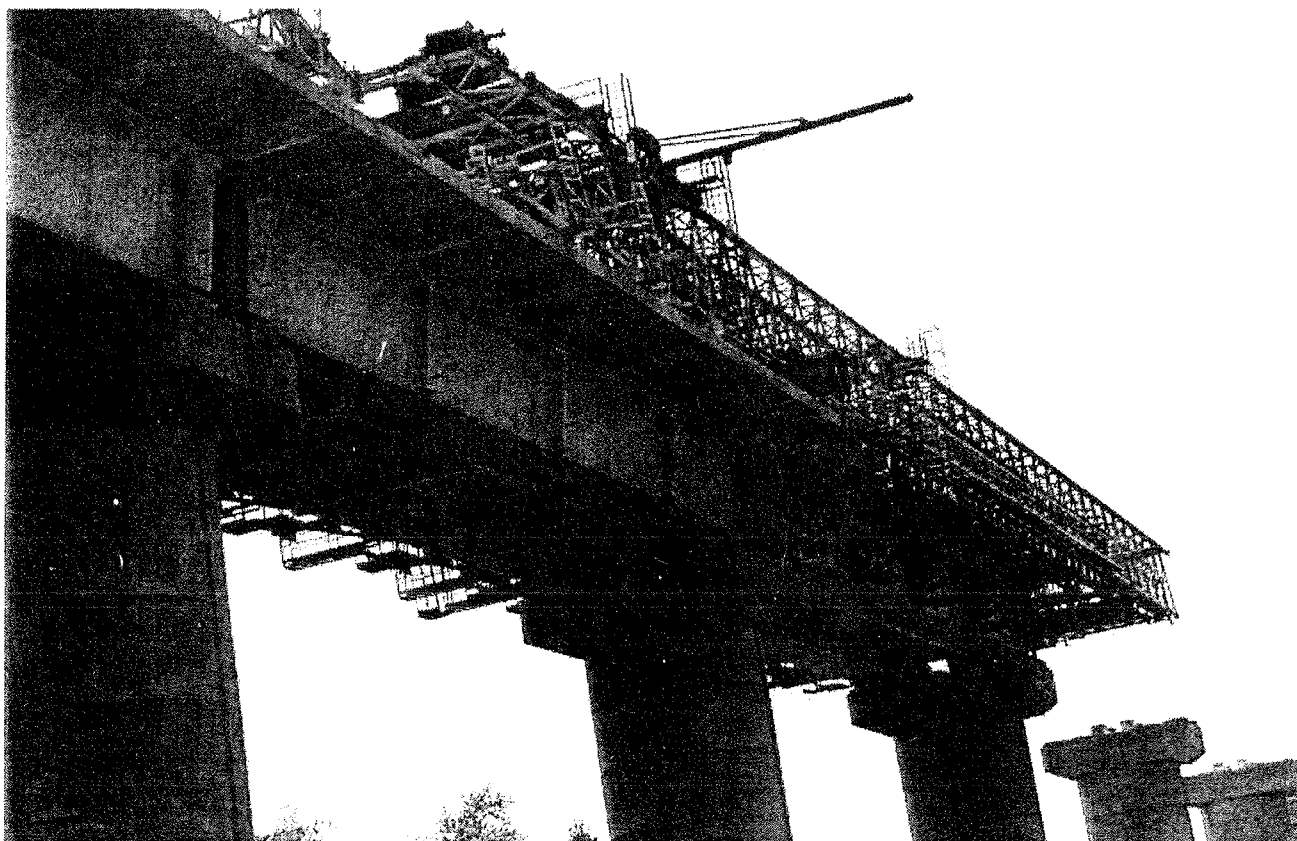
vista dal basso di una campata completa appena terminata e della successiva durante la fase di posizionamento delle lastre prefabbricate.
